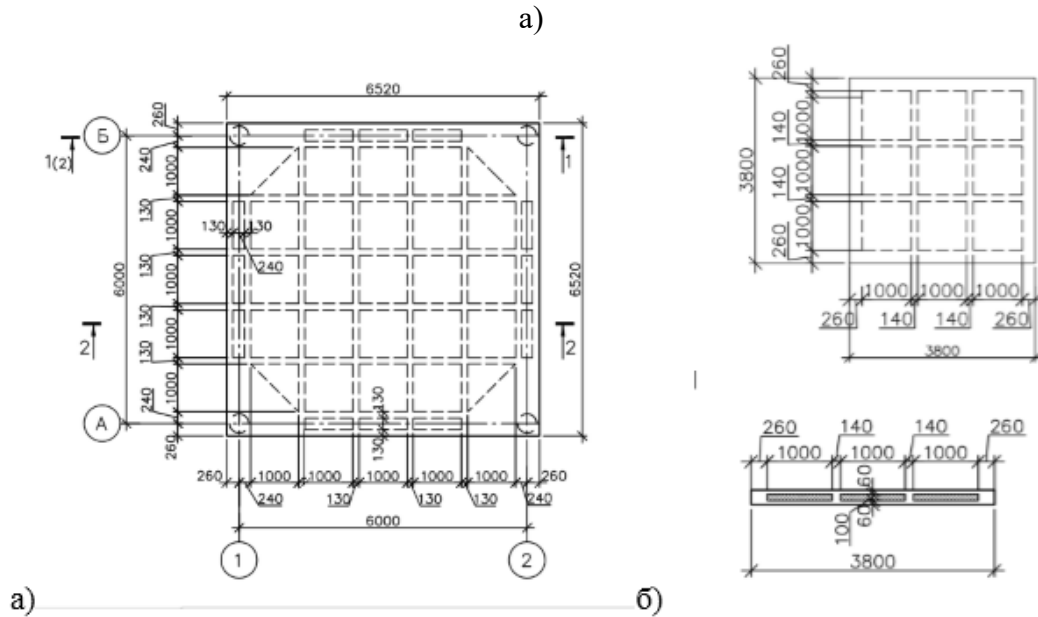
Плита перекрытия системы «МОНОФАНТ»: а) плита перекрытия 6×6 м; б) поперечное и продольное сечение фрагмента плиты перекрытия 3×3 м
